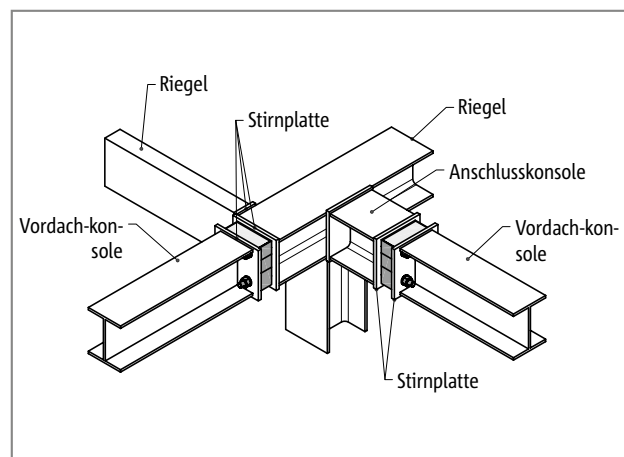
Schöck Isokorb® T Typ S: Aussenecke
